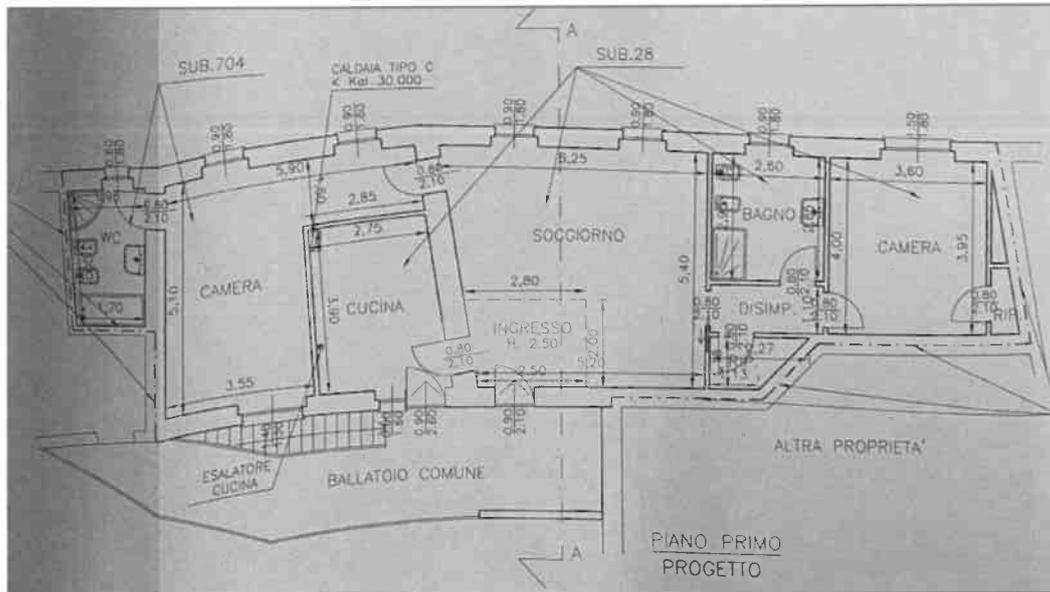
Estratto tavola Concessione Edilizia n. 23/2002 - progetto
